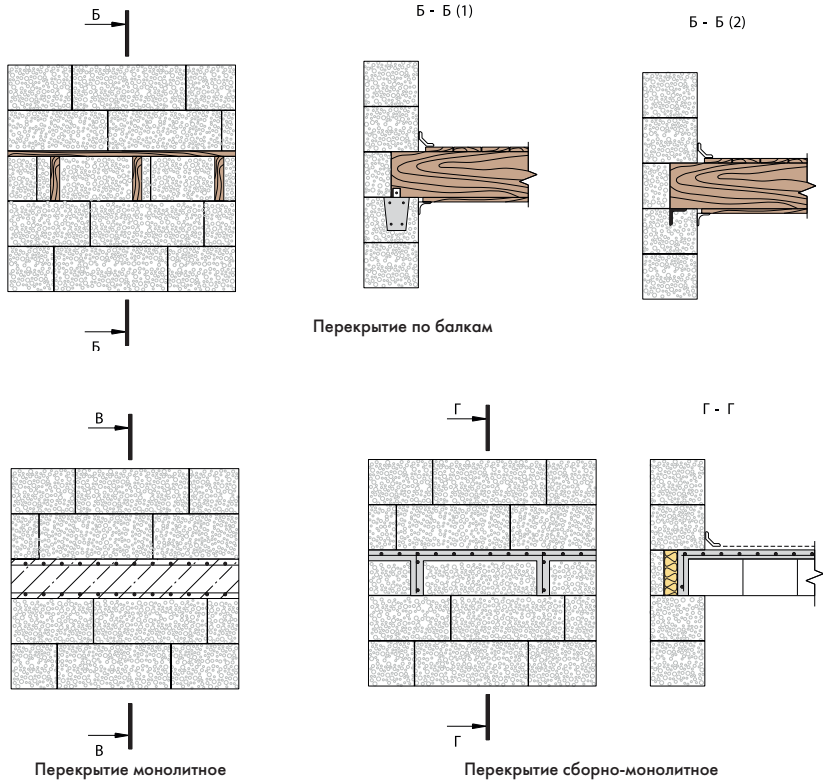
Варианты перекрытий по стенам из блоков AEROC
